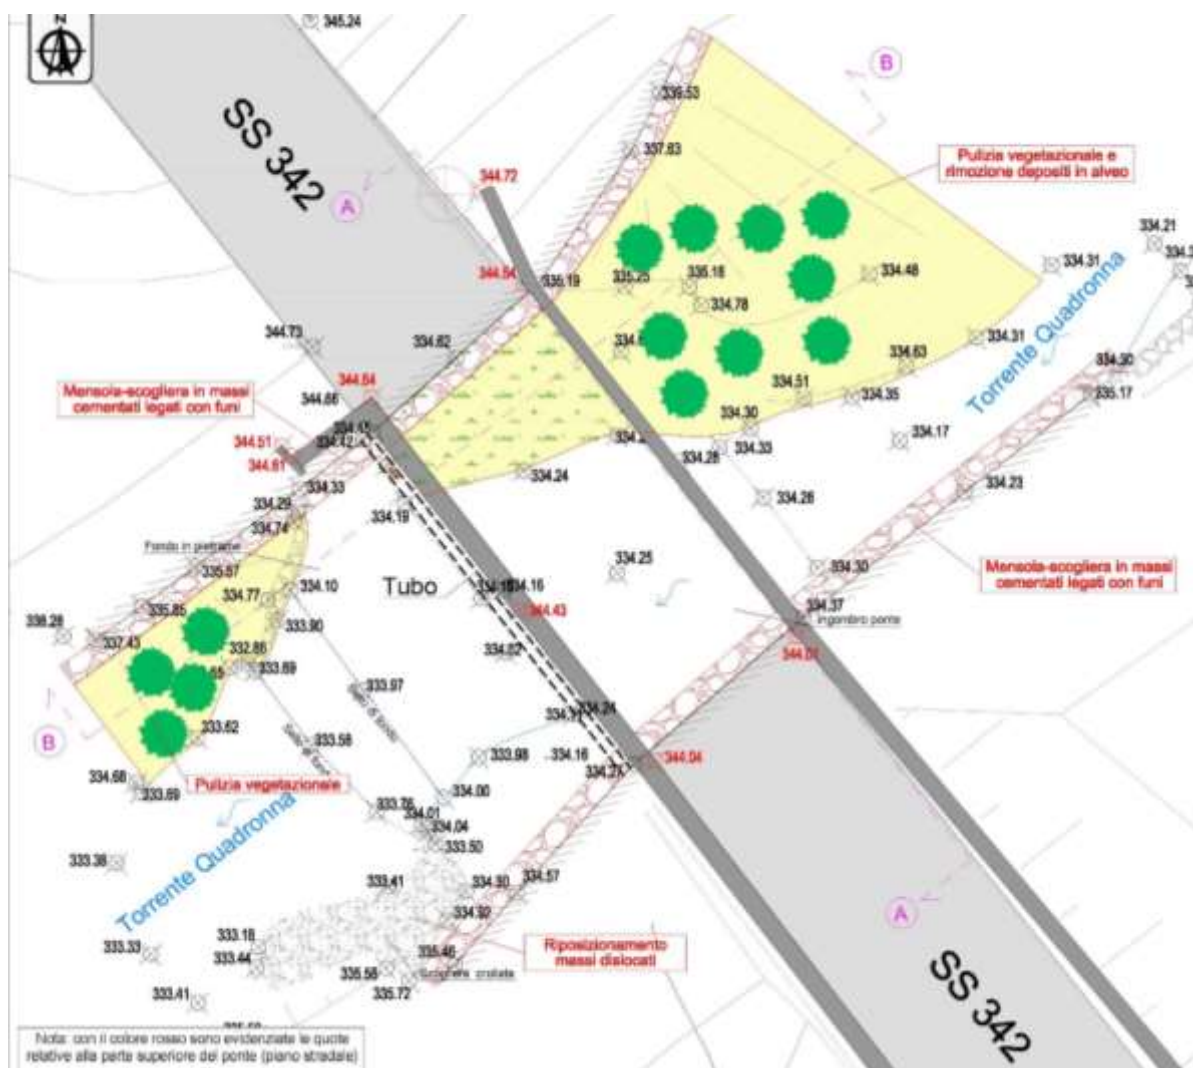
Planimetria di progetto (estratto Tavola 1.3)
